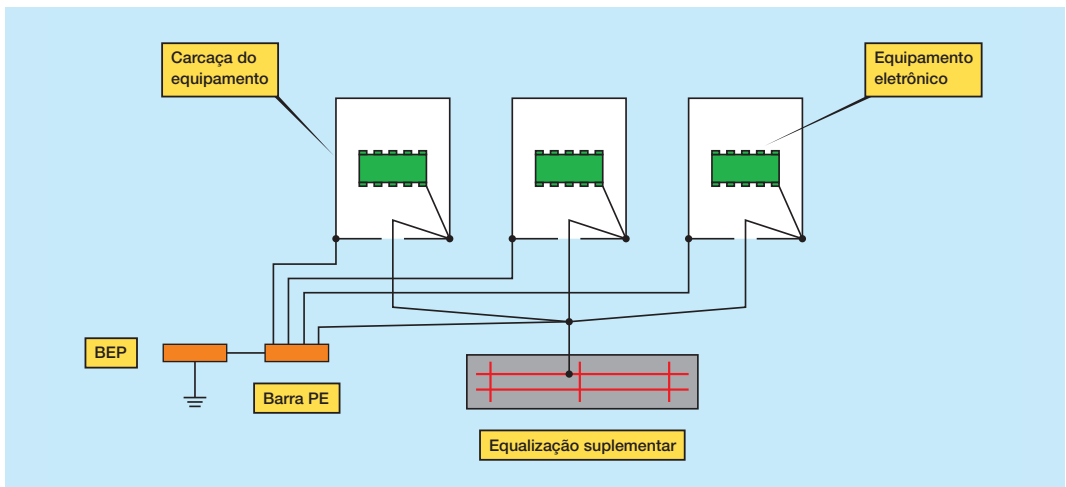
Interligação da carcaça ao condutor de proteção e à infraestrutura. Adaptado de [13].
